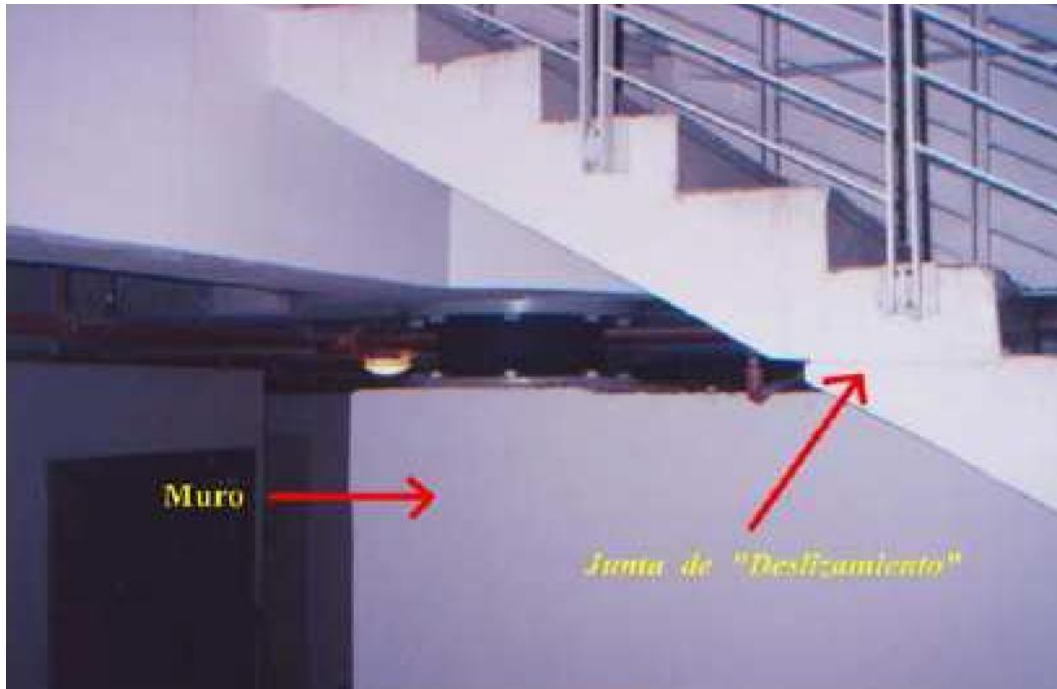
Aislador sobre muro, junta de desplazamiento
